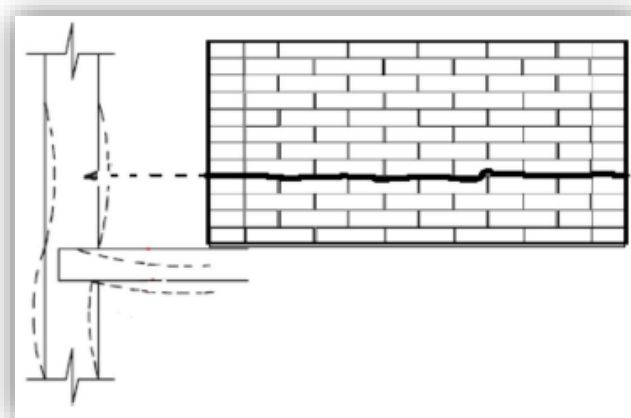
Fissuras horizontais derivadas de sobrecarga ou flexocompressão.
